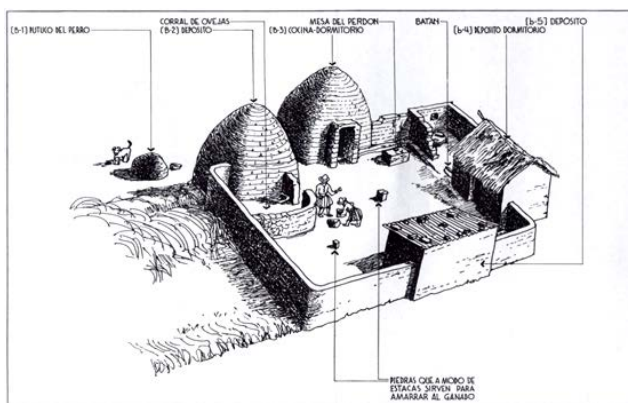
Vista isométrica del conjunto (Levantamiento desarrollado a la vivienda del señor Paulo Chambi, por el Arq. Ferruccio Marussi Castellan, 1999)
